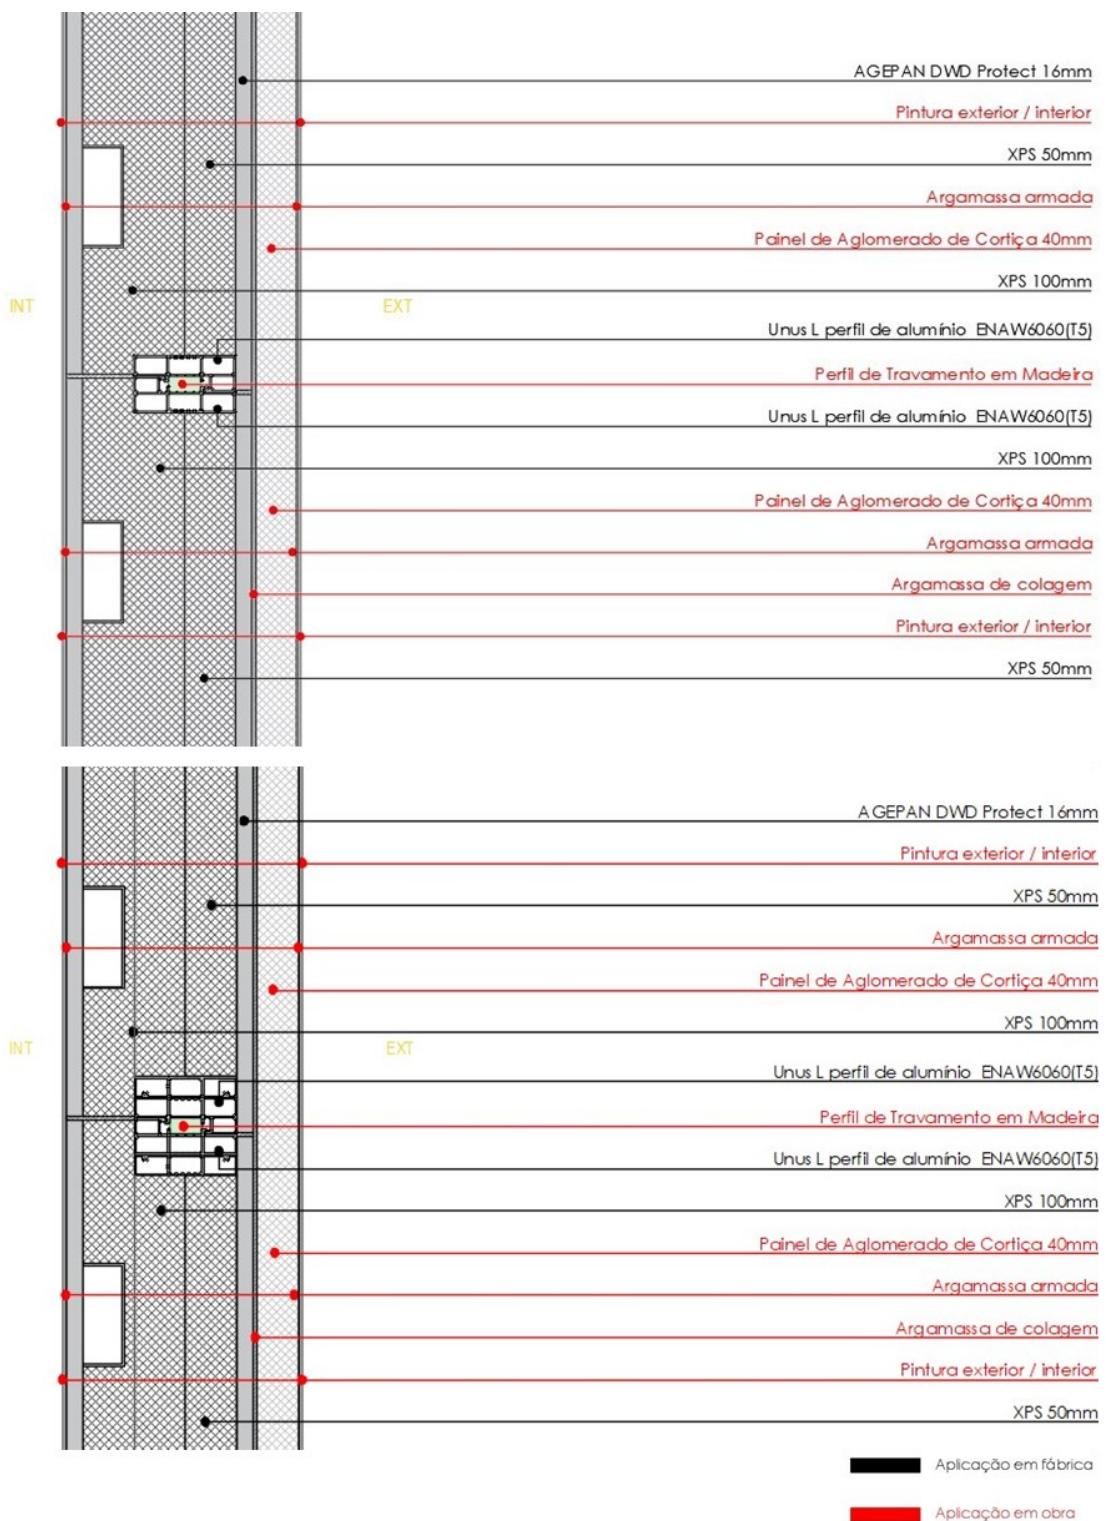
Solução Final – Pormenor construtivo de paredes verticais consecutivas, sem e com reforço.
